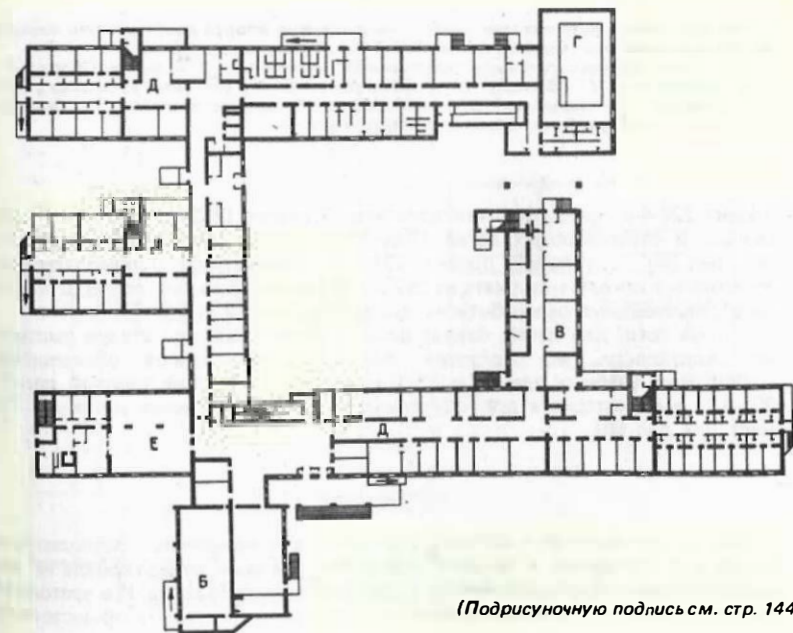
Специальная школа-интернат для 144 умственно отсталых детей (типовой проект 224-4-10). Фасад, планы этажей
